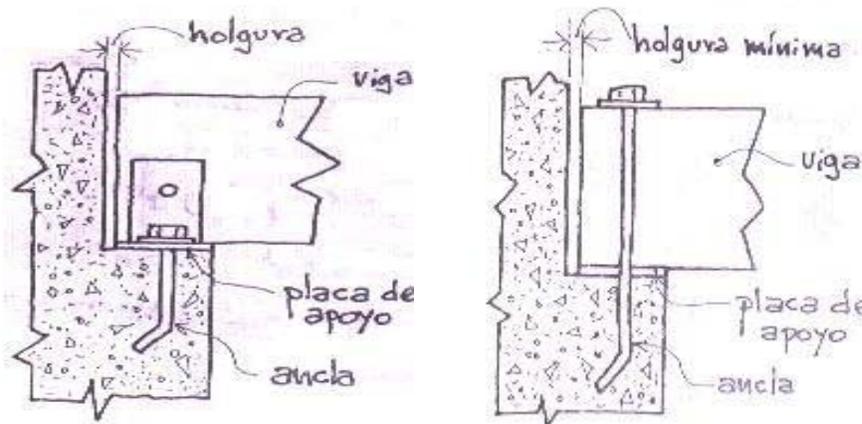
Vigas macizas apoyadas y sujetas sobre concreto.
